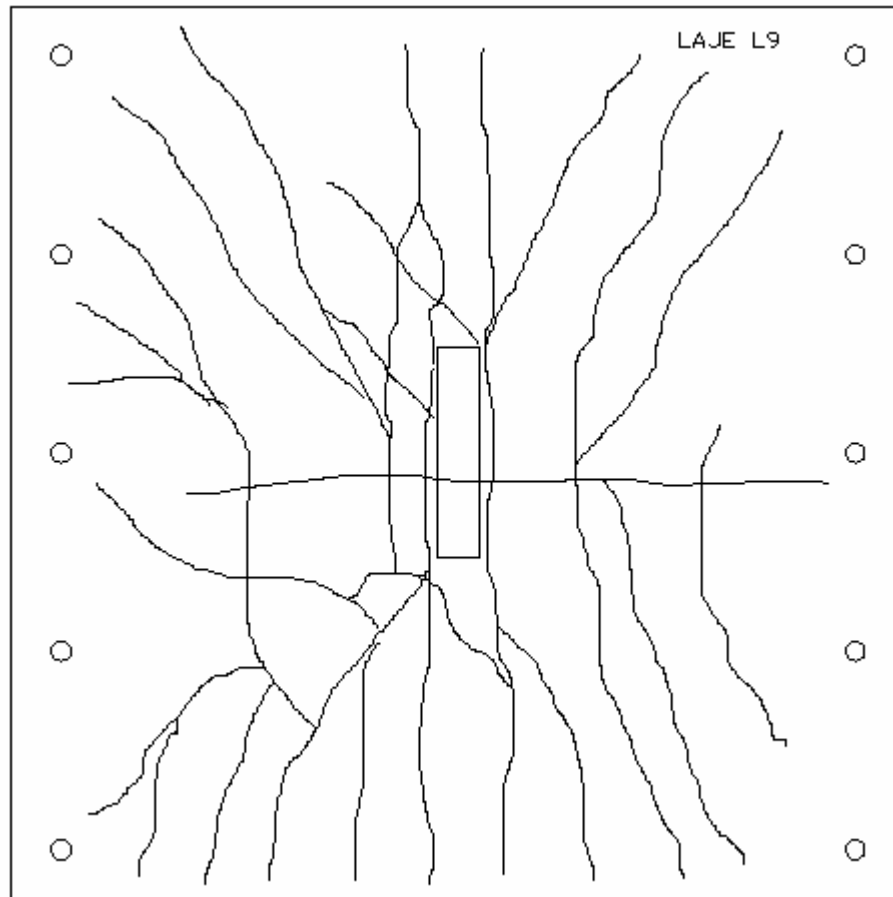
Mapa de fissuração da laje L9
